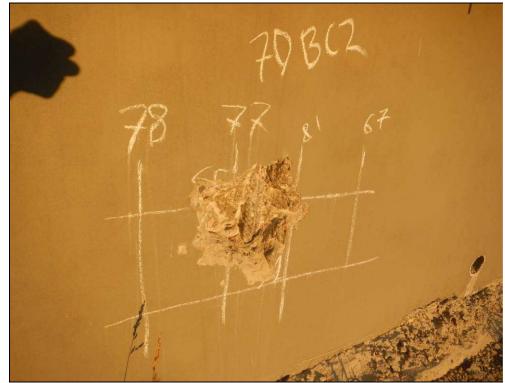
Участок исследования армирования конструкции стены СТ-70 магнитным методом прибором «Profometer 5» (числами отмечена величина защитного слоя) с последующим вскрытием арматуры конструкции стены
